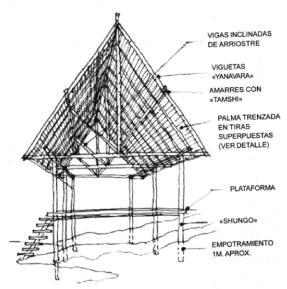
Sistema constructivo, estructura de troncos rollizos, techos de palma. (Burga, J., 2010)
